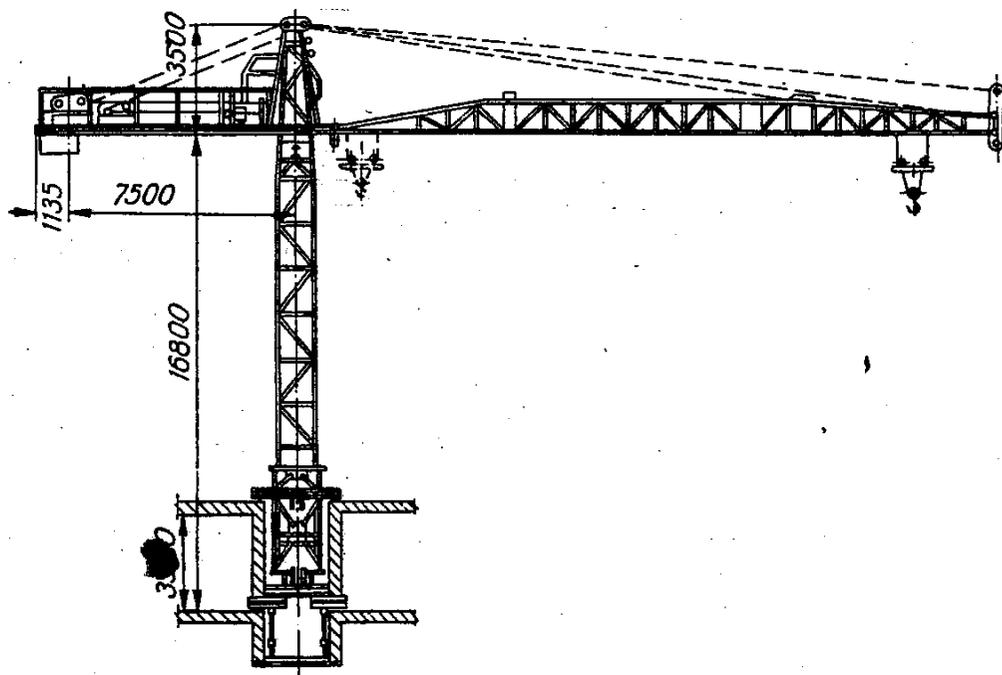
Башенный самоподъемный кран УБК-1,5-49
